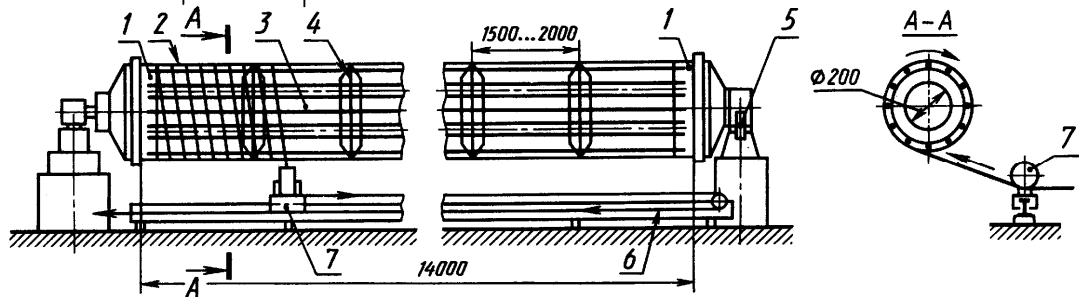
Станок для изготовления арматурного каркаса свай - оболочек
